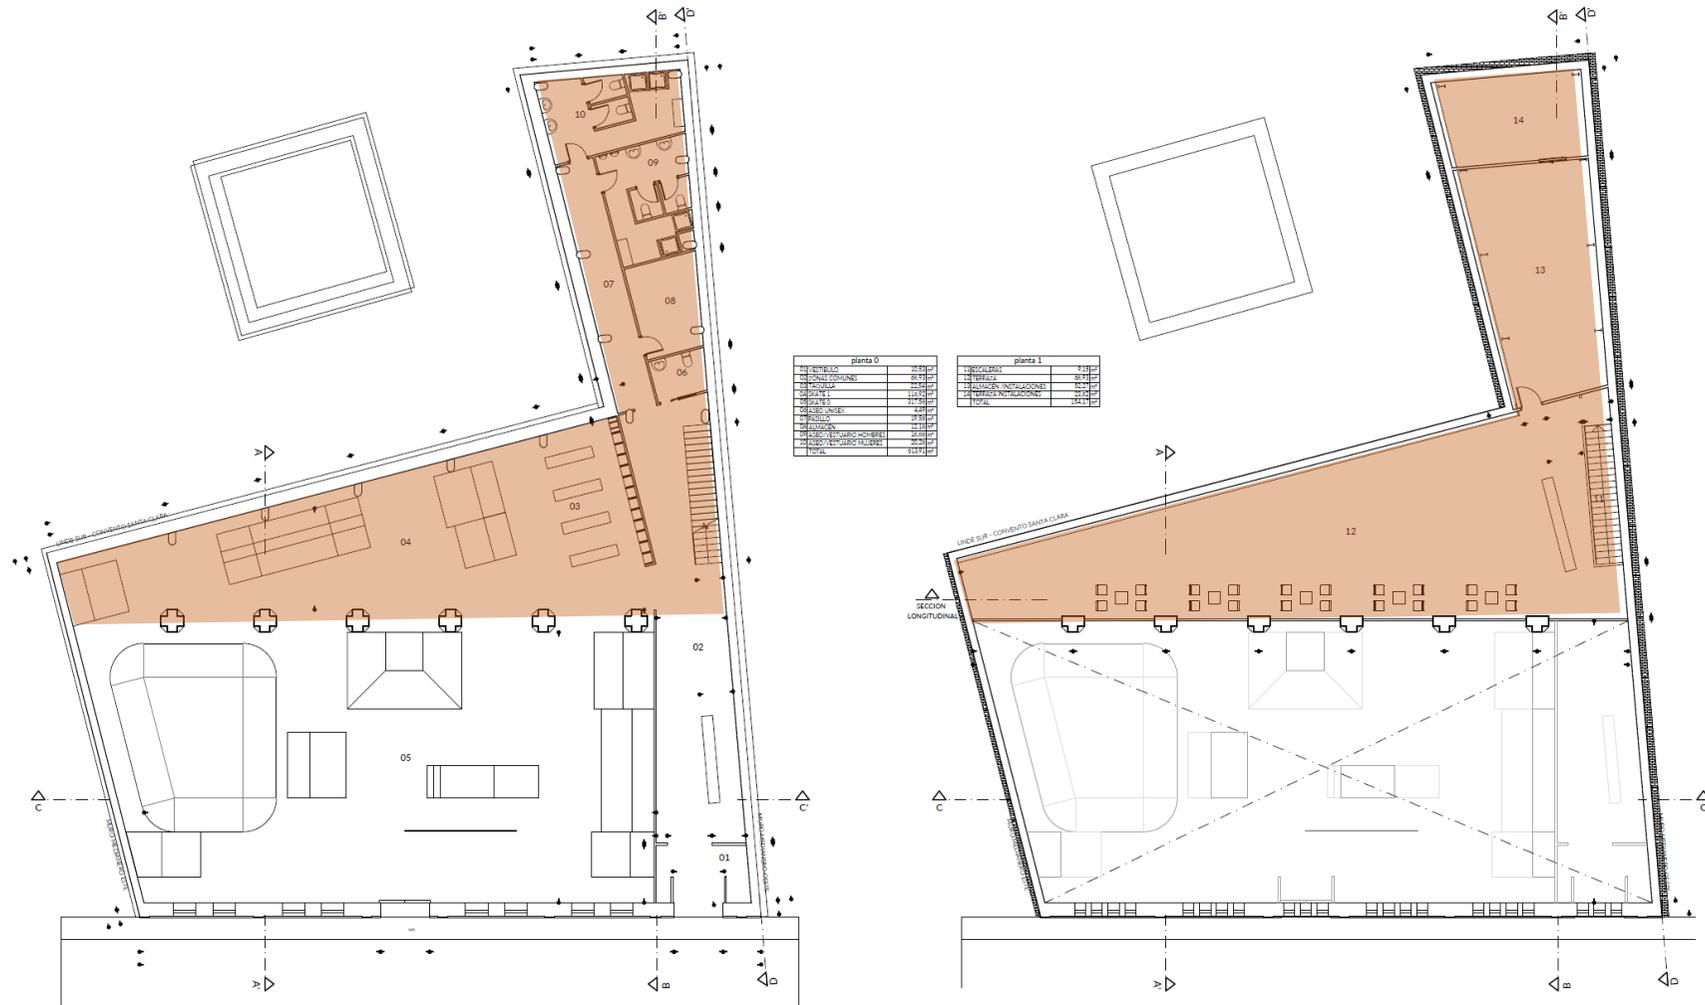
Planta baja y 1º del anteproyecto definitivo y demarcada la zona de intervención y de rehabilitación. Elaboración propia.
